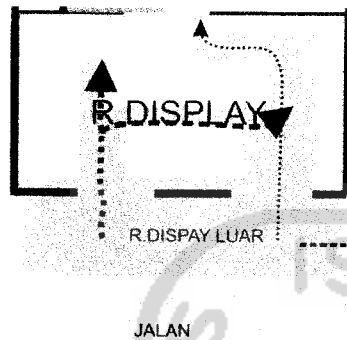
Alternatif penataan layout (Bar. 1984:44)
